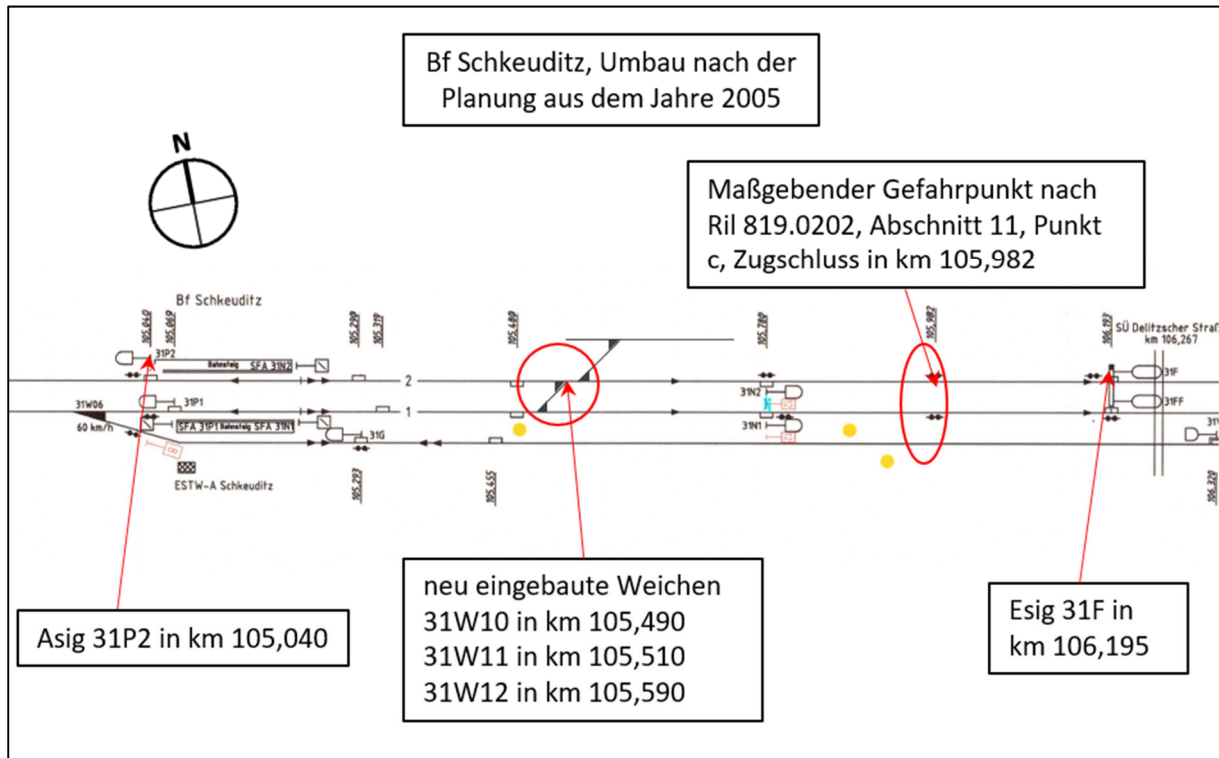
Bf Schkeuditz Lageplan nach der Gesamtplanung aus dem Jahre 2005⁷
